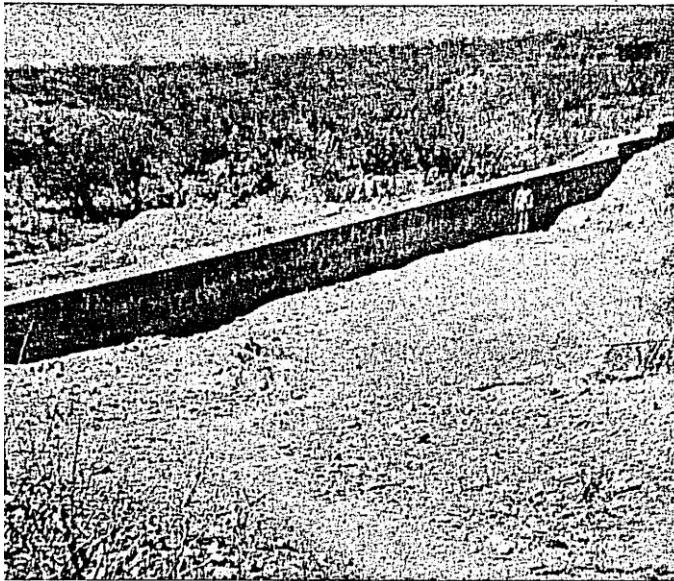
Escama-peixe, estrutura de alvenaria à prova de reingresso de piranhas, construído a jusante do sangradouro do açude "Paço da Cruz", Estado de Pernambuco.
